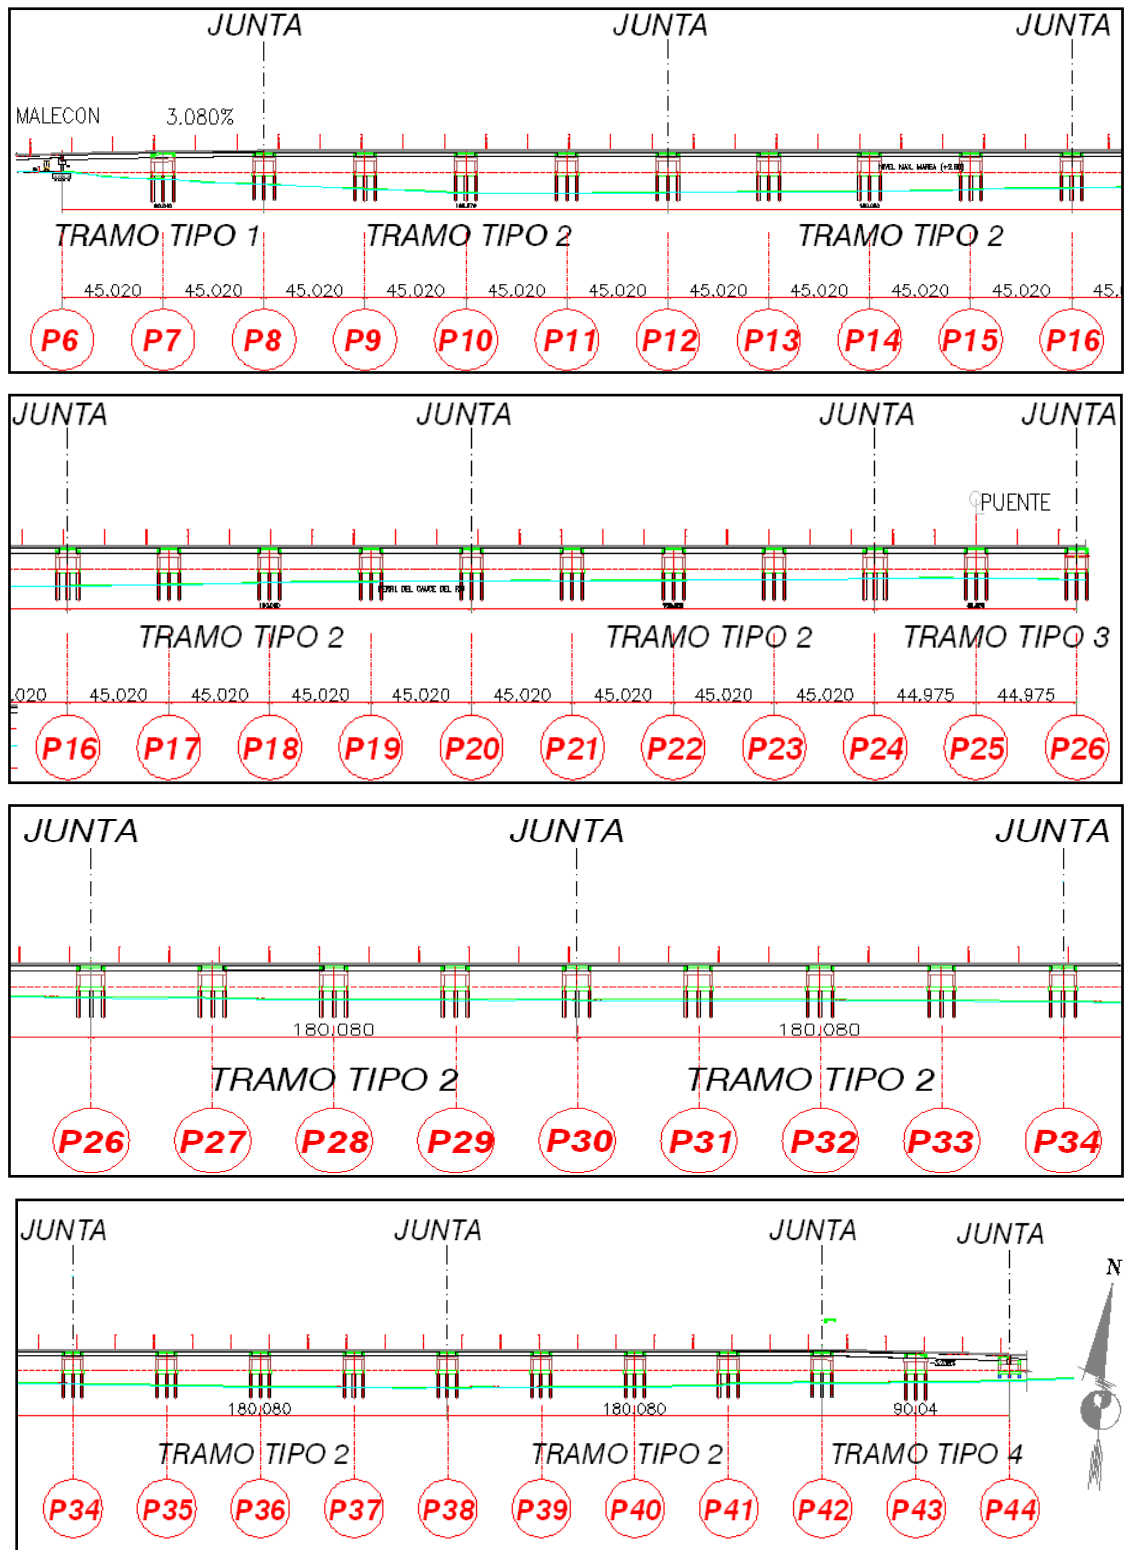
14: Vista Longitudinal desde el estribo hasta el eje central del puente (CEE,
